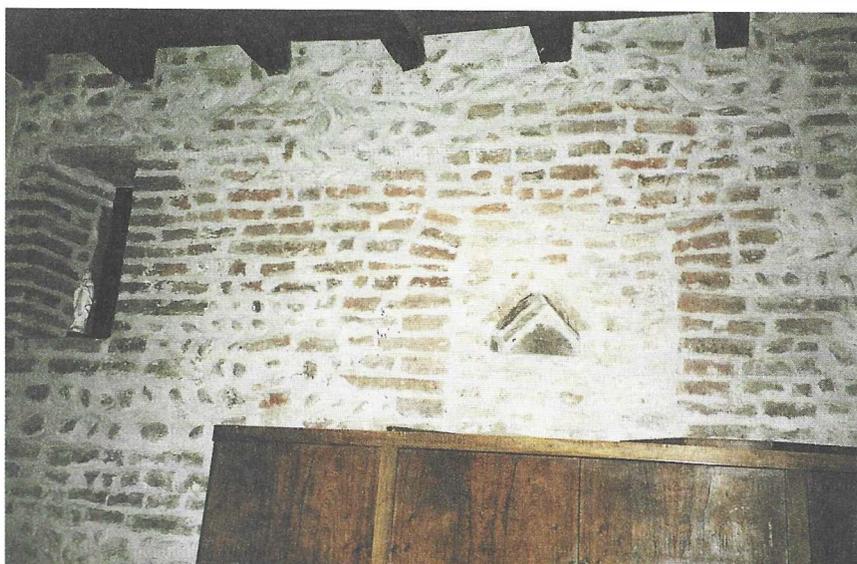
Piazza Canonica di San Pietro, n.14, primo piano, vano 9: muro o.
